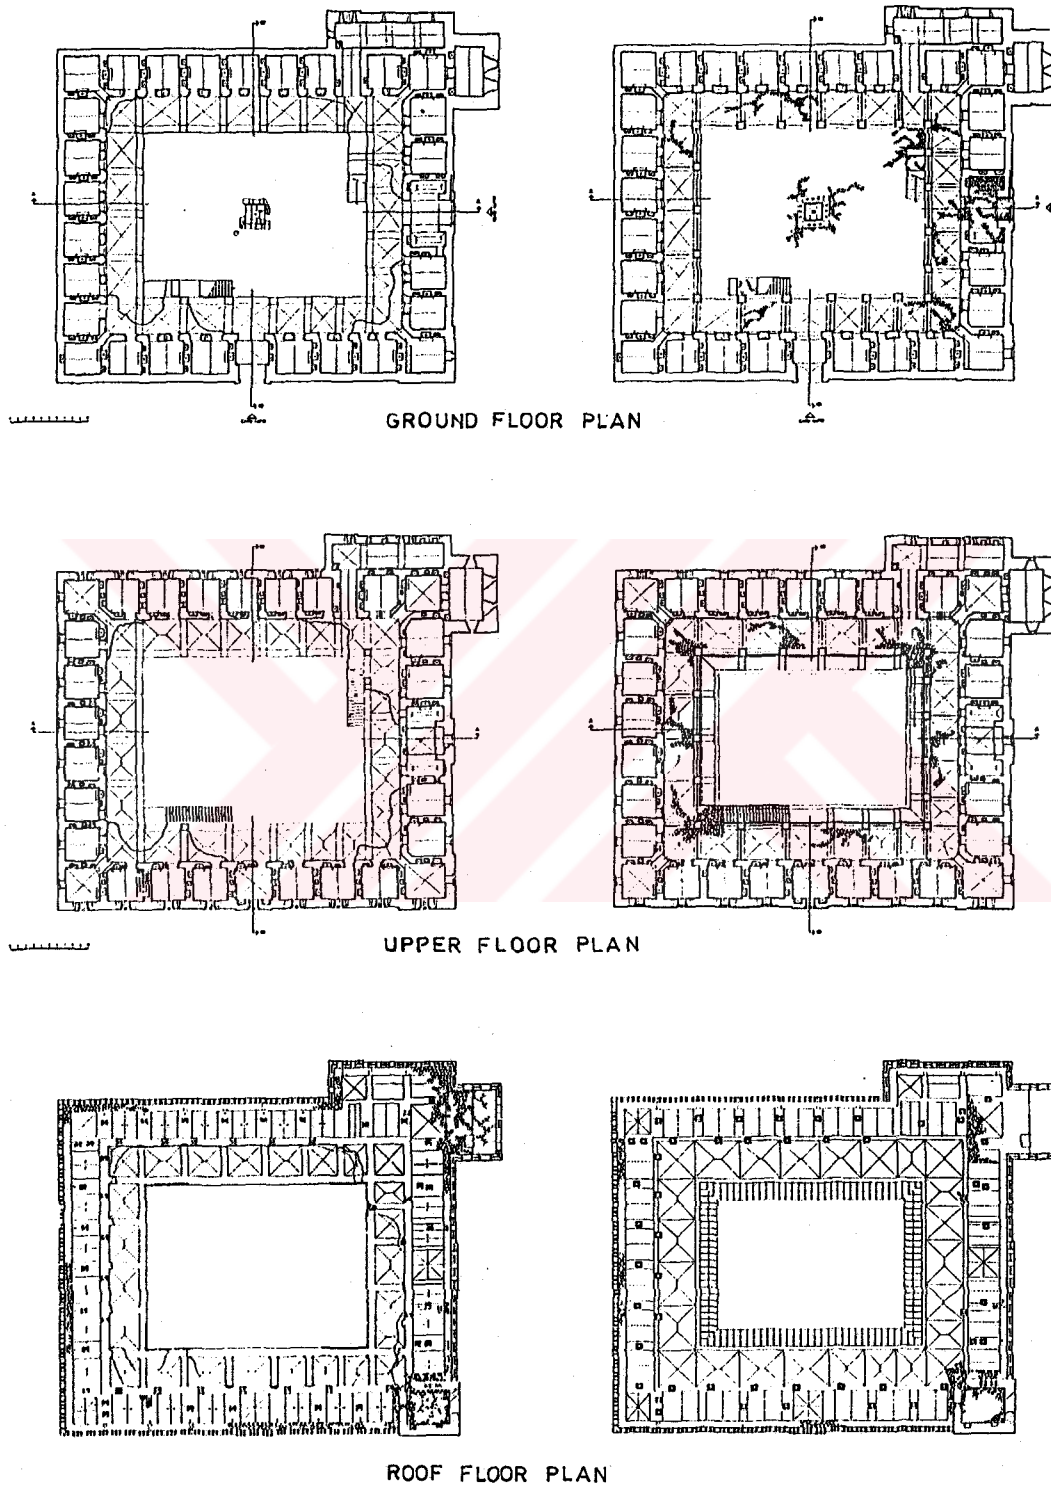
Öküz Mehmet Paşa Caravanserai in Kuşadası - Plan Drawings
